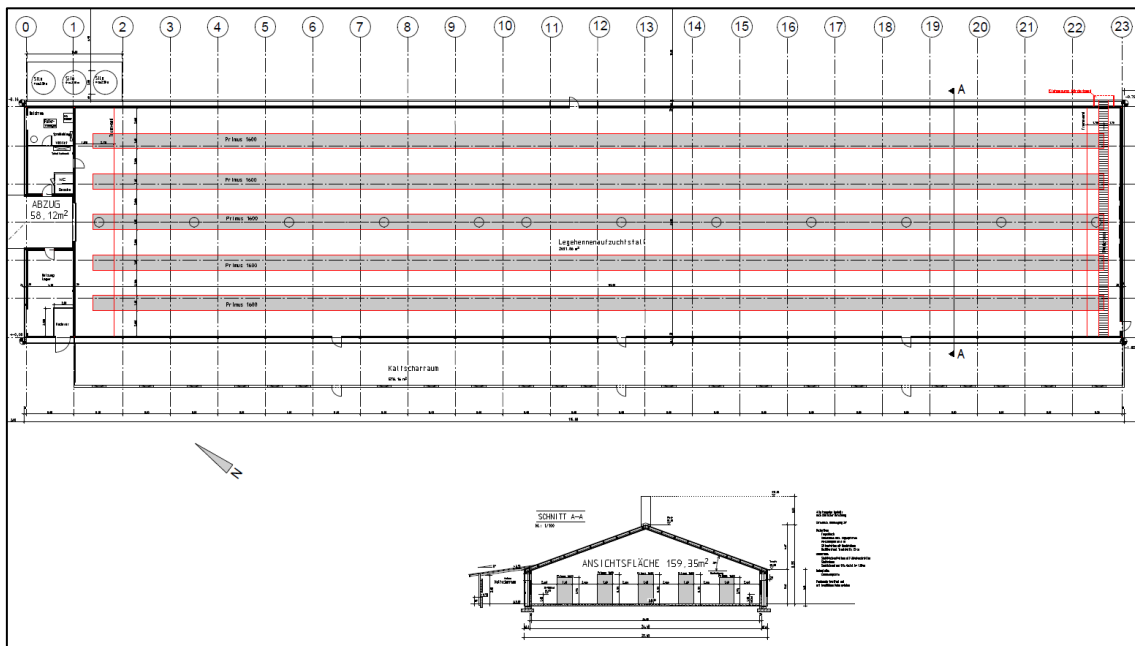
Stallgrundriss des Junghennenaufzuchtstalles (Ingenieurbüro Rausch und Partner)
